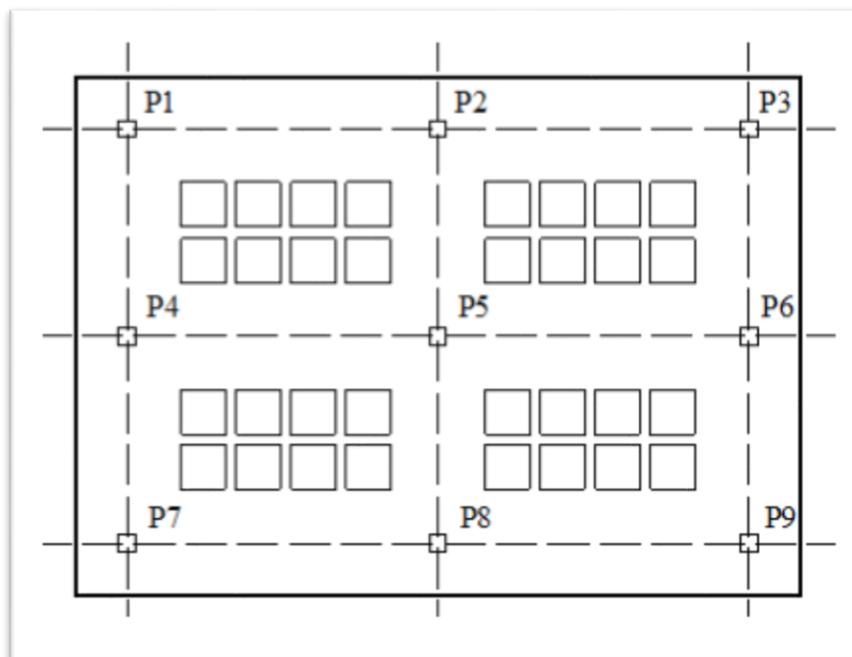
Pavimento de lajes nervuradas sem vigas.
